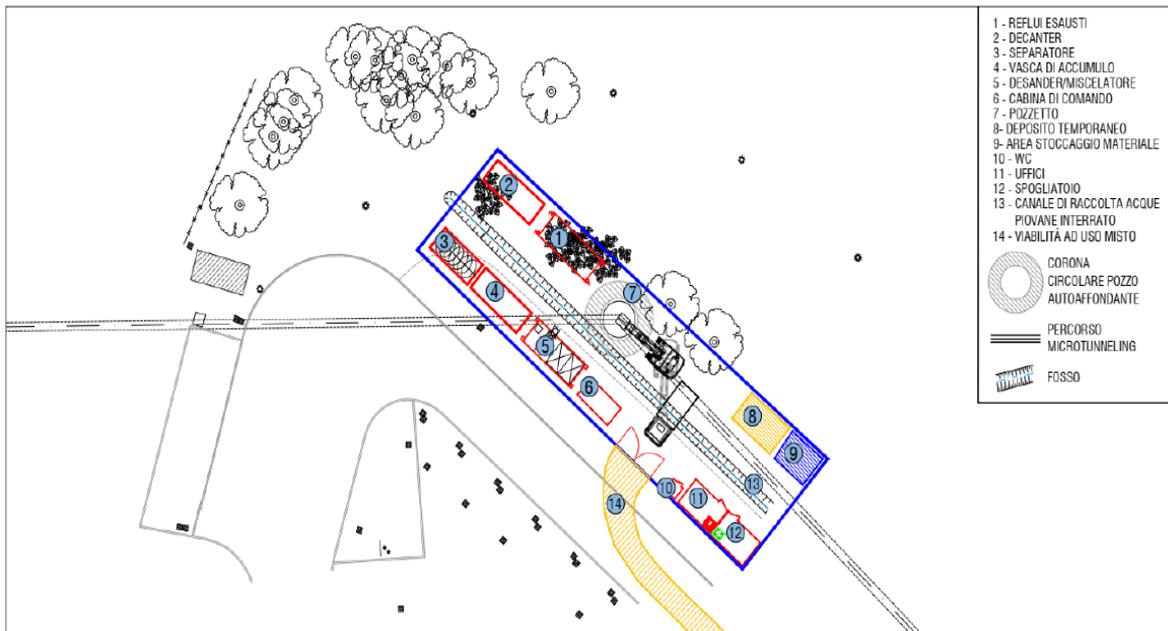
Schema del cantiere microtunneling del pozzo di spinta 2a.
